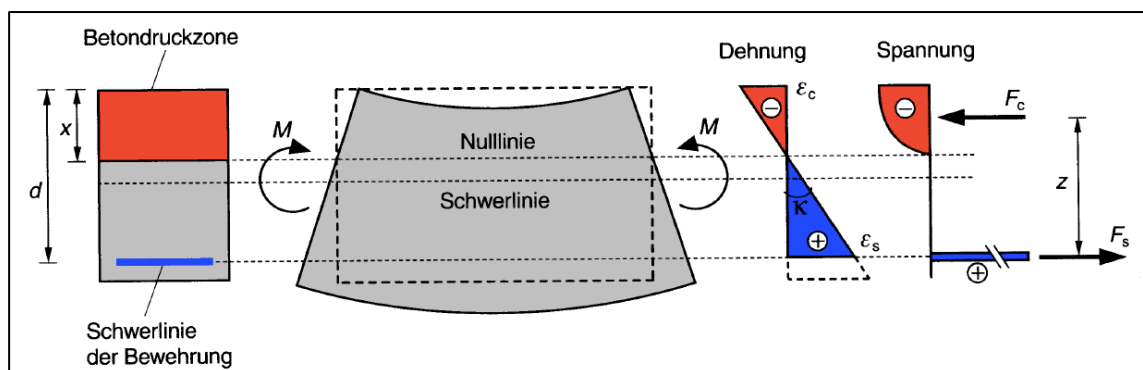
Stahlbetonbauteil unter Biegung, nach Rissbildung [57]
